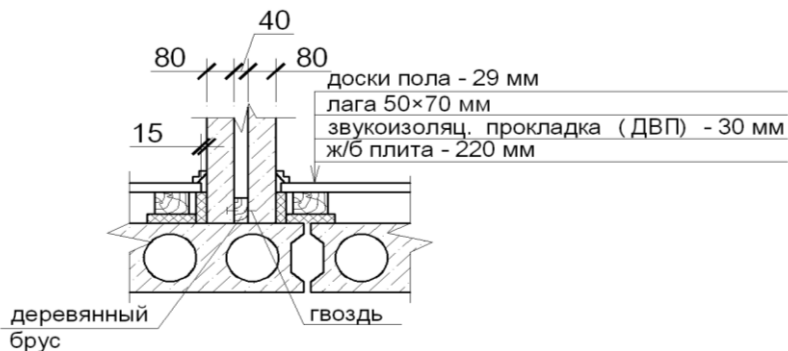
Междуетажное перекрытие в жилых комнатах
